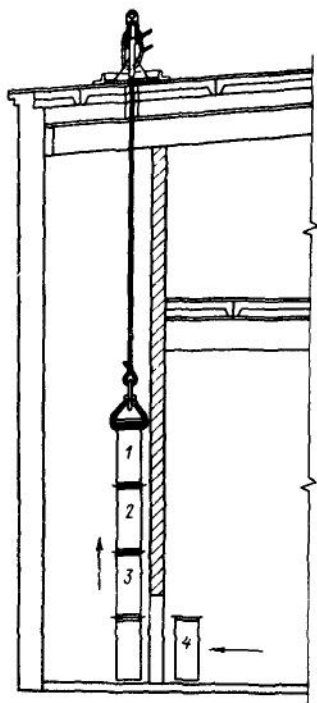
Монтаж вертикальных воздуховодов методом наращивания снизу:
